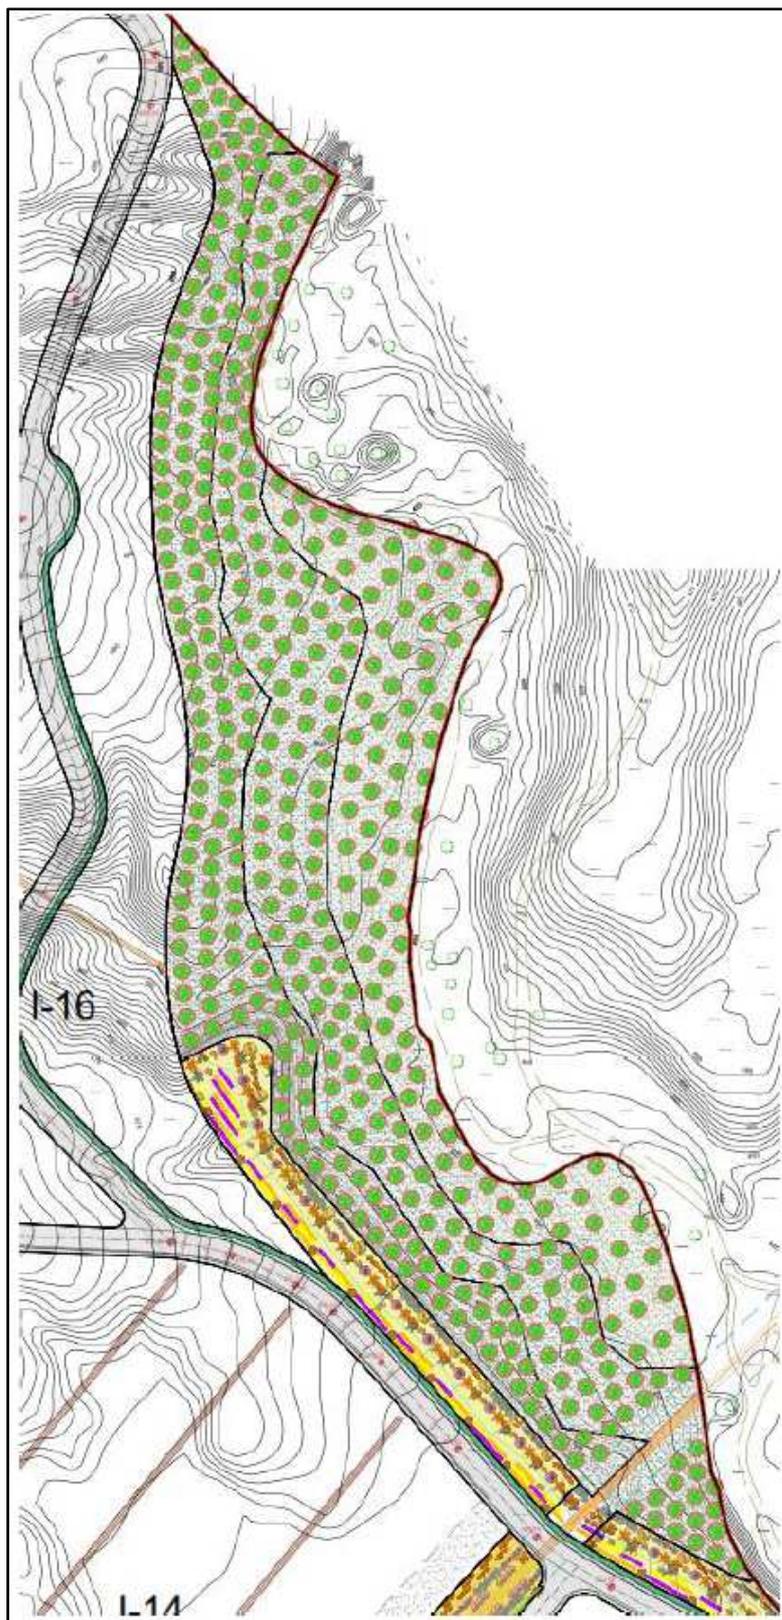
Proyecto en el ámbito de la DC-02 REFORESTACIÓN.
